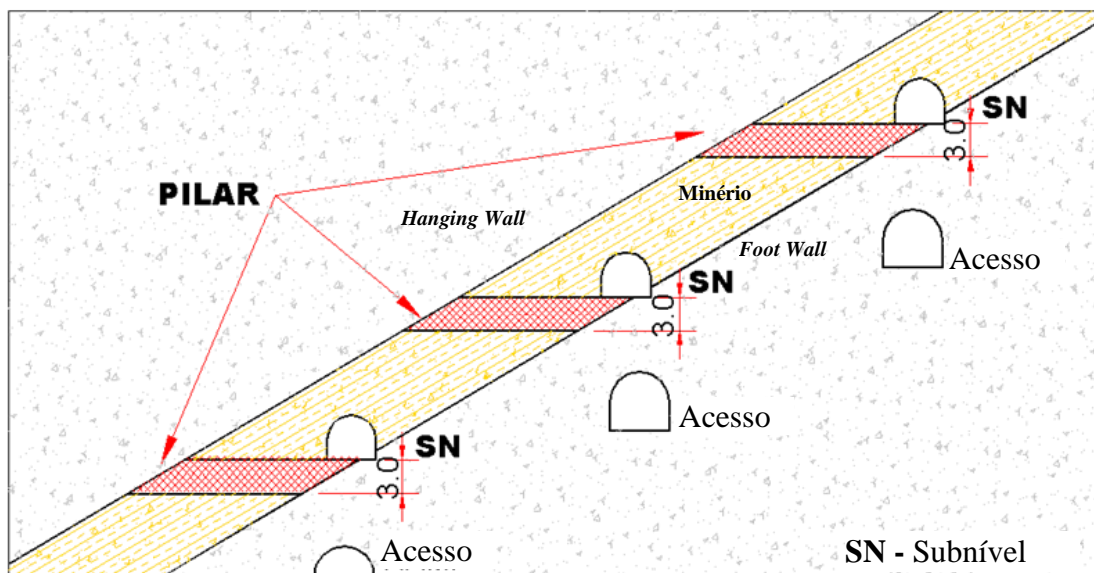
Perfil esquemático com painéis e pilares horizontais (*sill pillar*).
